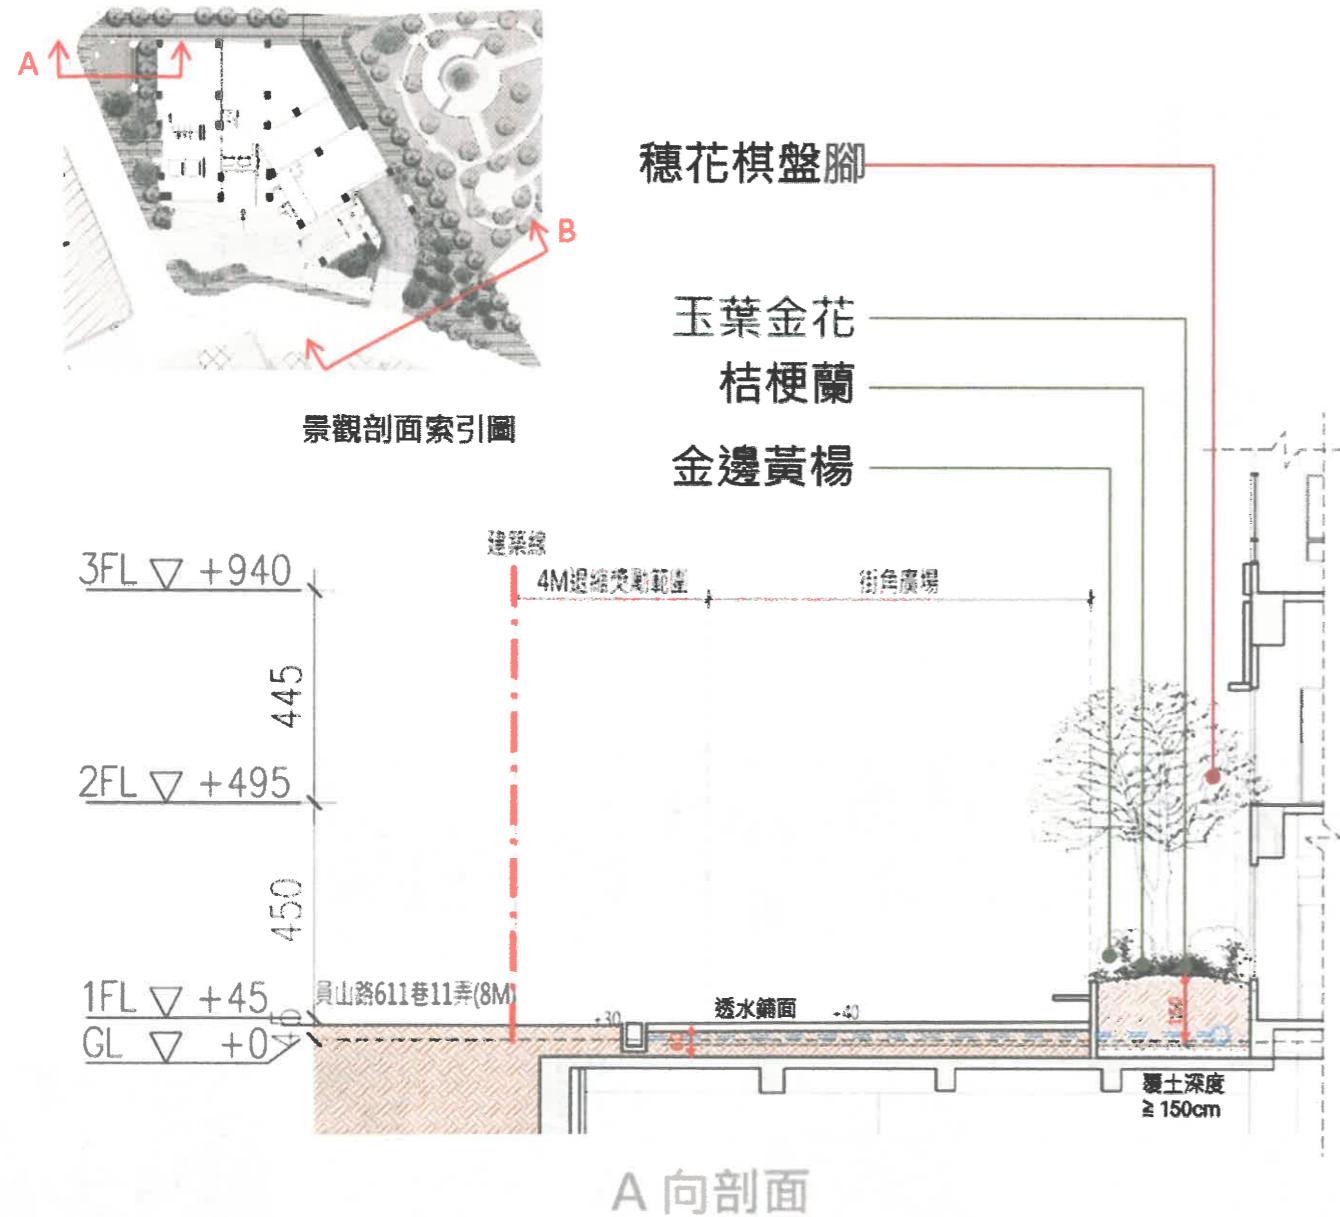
地面層景觀剖面示意圖 1(維持原核定)
